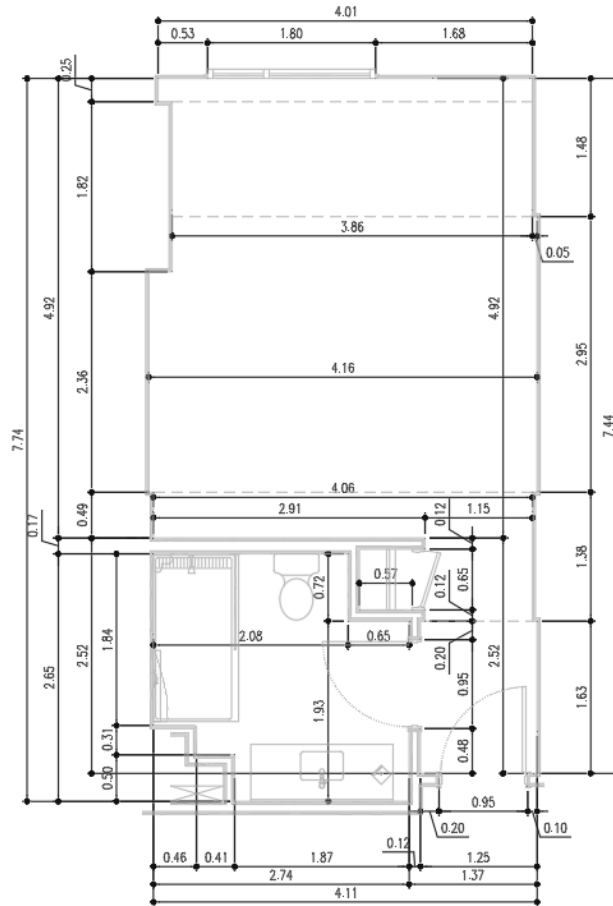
Planta Constructiva Habitación Tipo King Hotel Courtyard
